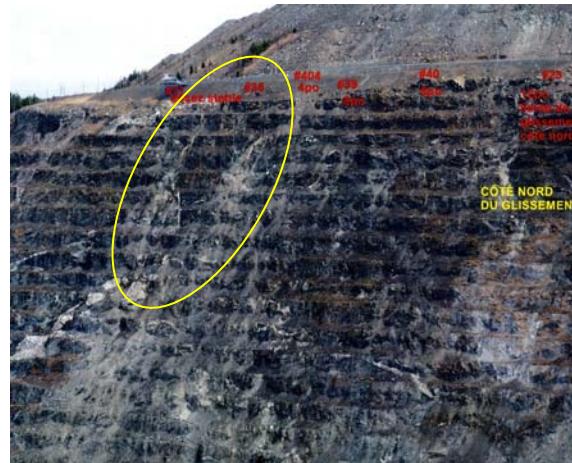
Rupture en dièdre en formation qui se répercute sur la chaussée abandonnée (photo 9).
